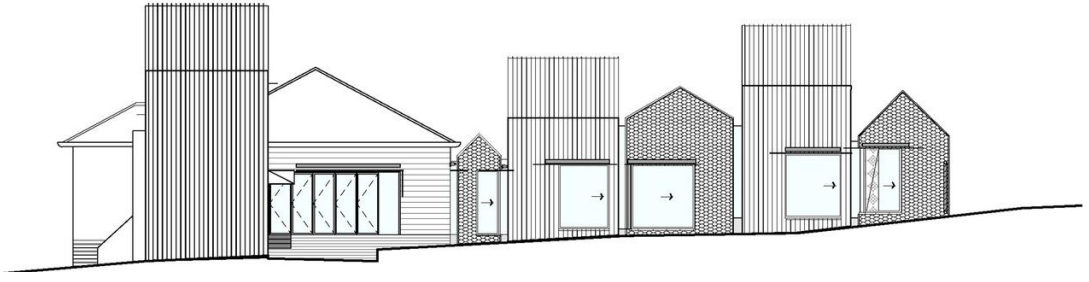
Kule Ev (Tower House) vaziyet planı;
